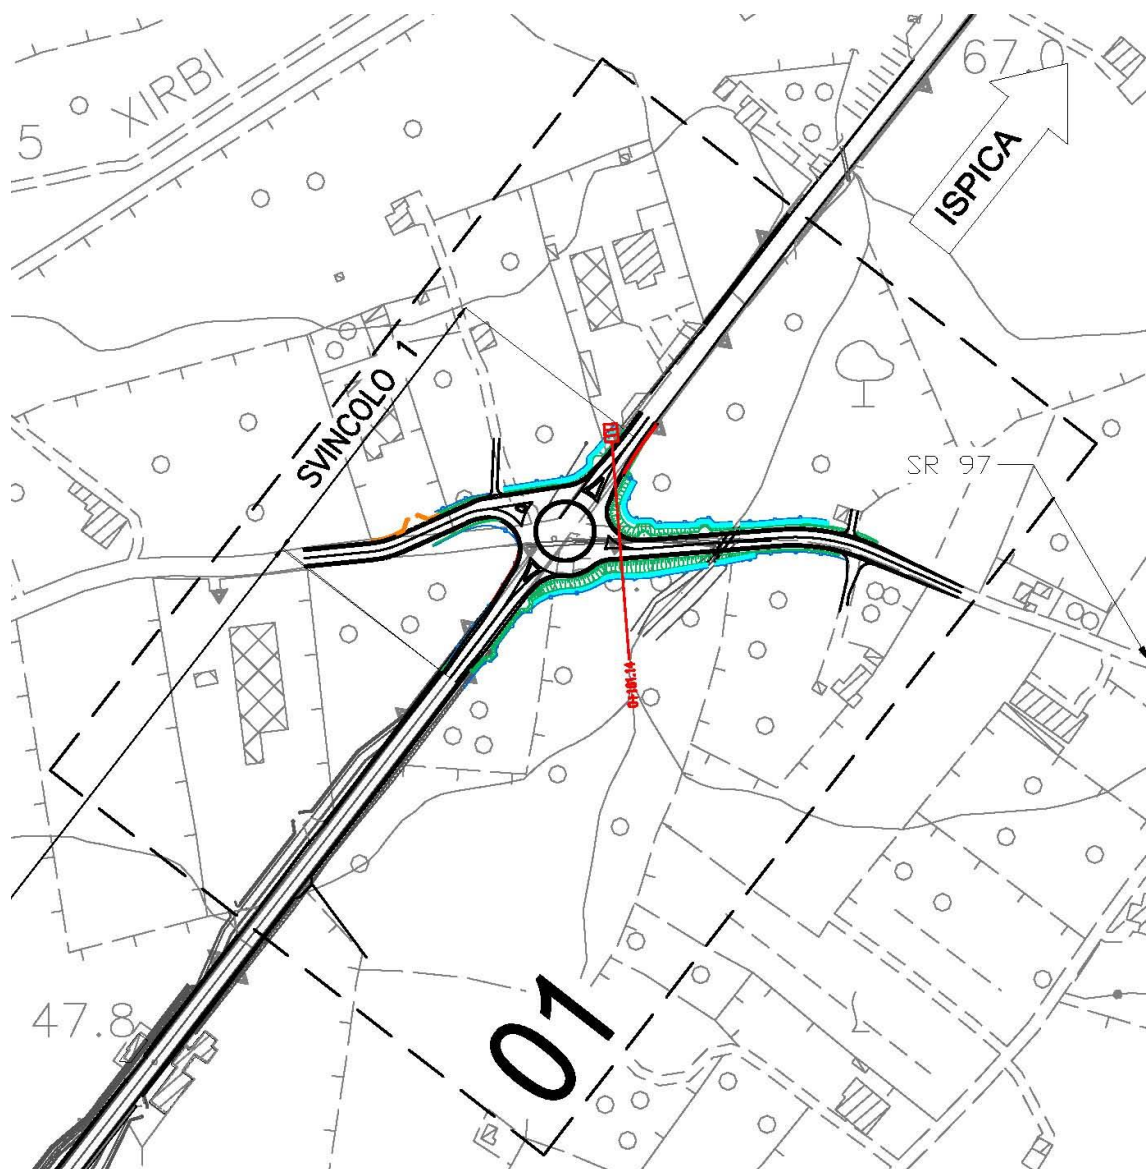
Ubicazione Planimetrica della Sezione In Rilevato di Riferimento
